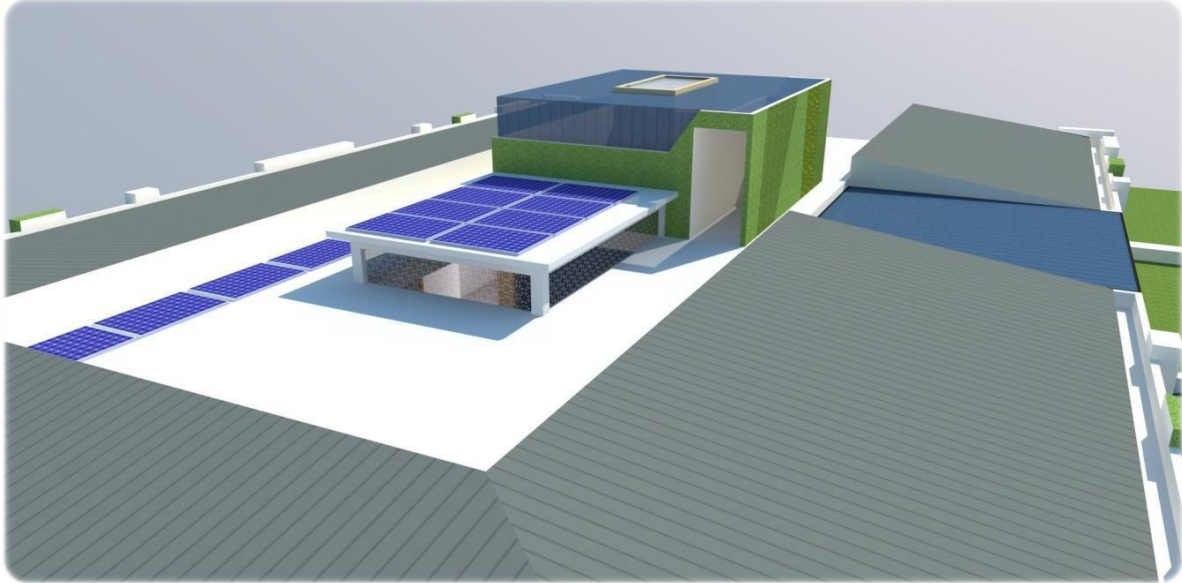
VISTA DE AZOTEA EN EDIFICIO ADMINISTRATIVO, FACHADA PONIENTE
